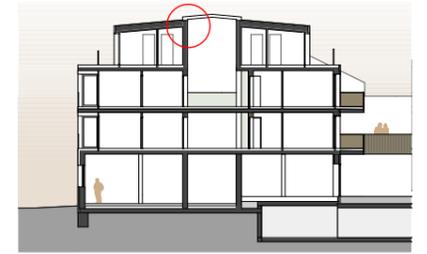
Bauteil 1: Anschluss Glasdach 1:10
